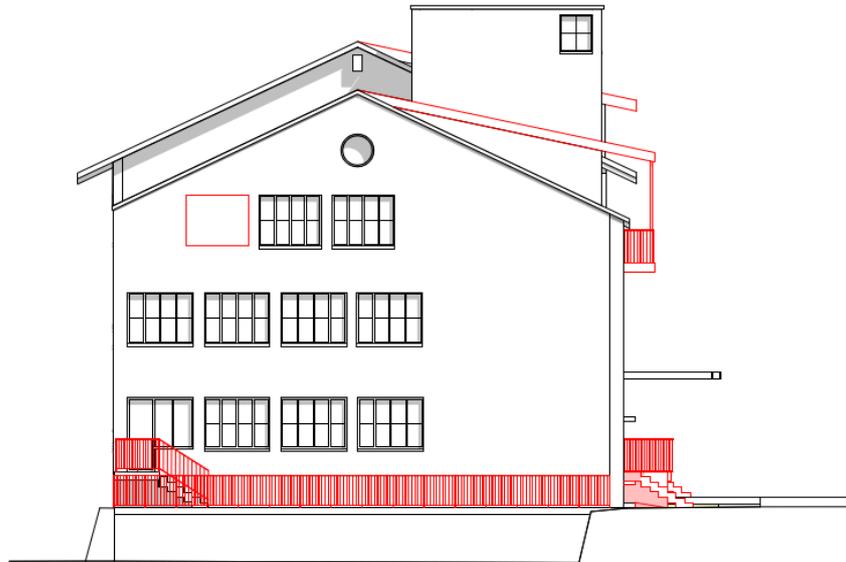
Fassadenansicht Südfassade Bestandsbau H25 (Quelle: Machbarkeitsstudie H25, Salewski Nater Kretz Architekten)
